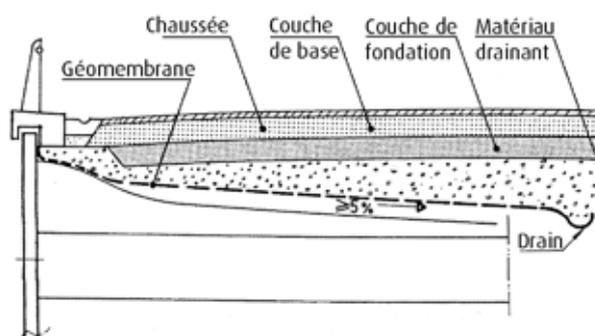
Exemple d'étanchéité sur ouvrage de soutènement en remblai renforcé (extrait du guide de conception générale « Les ouvrages de soutènement »)
